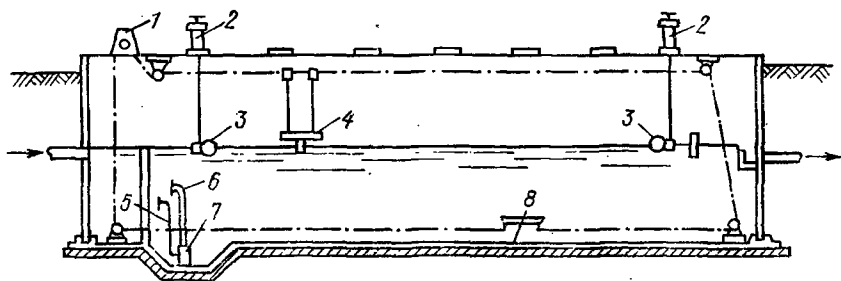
Устройство нефтеловушки из сборных железобетонных элементов производительностью 20—40 м³/ч.
